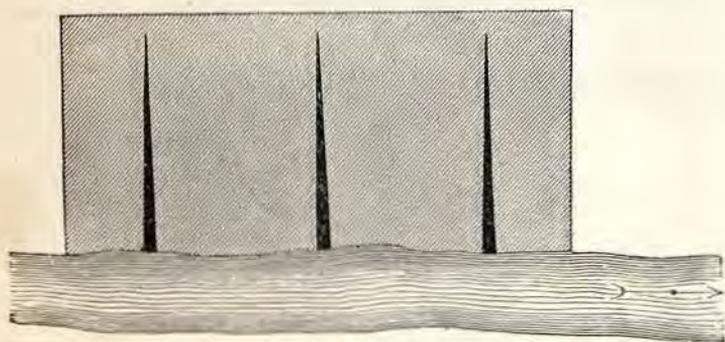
Figura schematica indicante l'ampiezza di sezione necessaria per i canali secondo il sistema Liernur.
